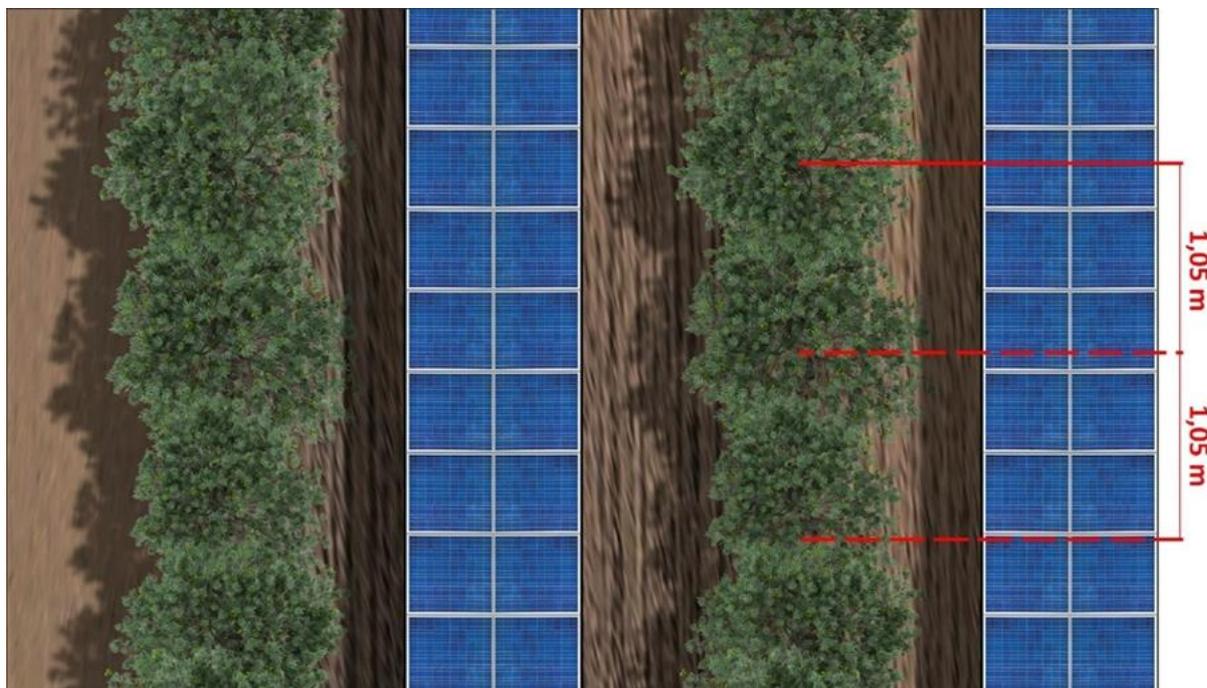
tipologico - vista planimetrica dell'impianto olivicolo
